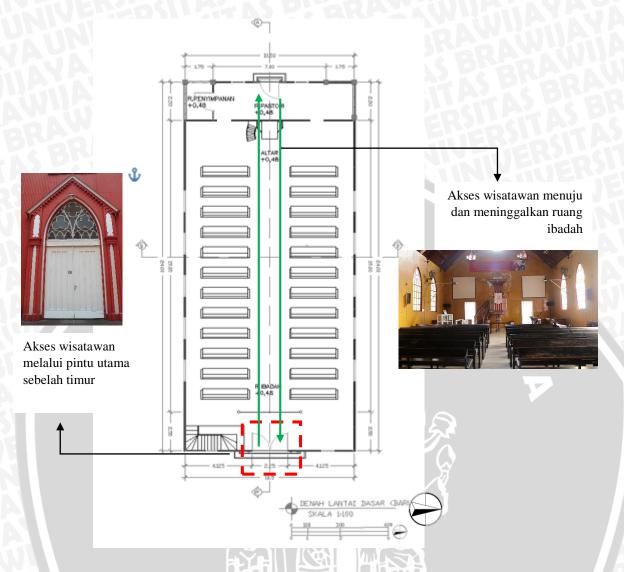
Organisasi Ruang Pada Bangunan Gereja Merah
